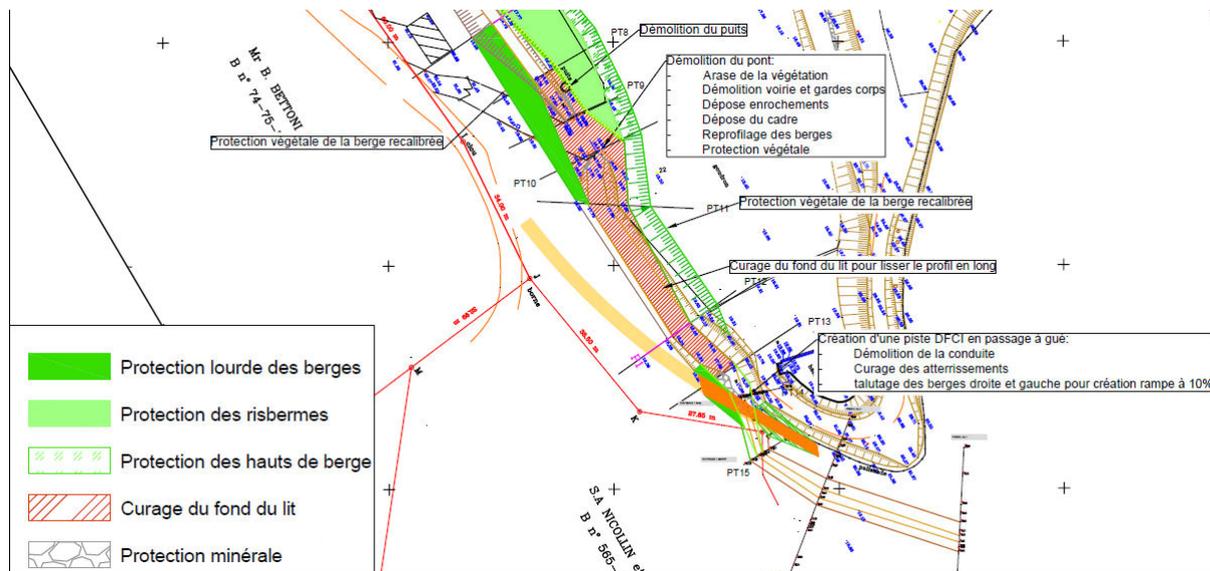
Plan du projet d'aménagement du Maravéou aval
